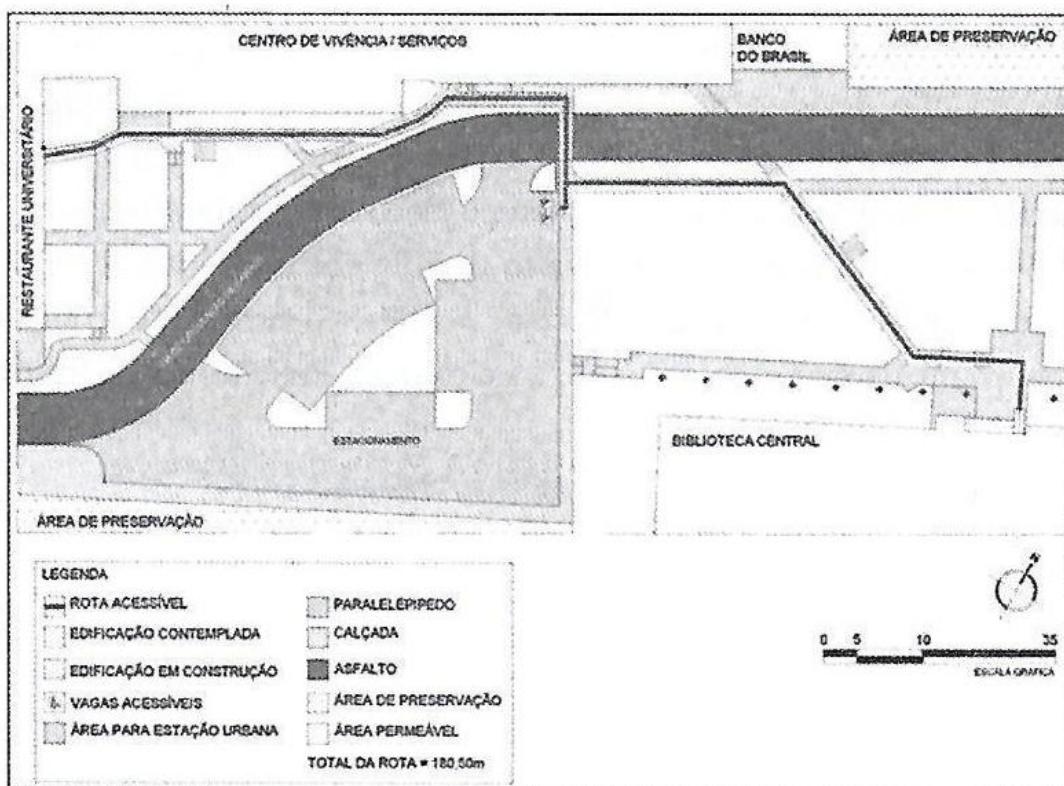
Planta Baixa da TPRA no Campus I – UFPB. Fonte: Acervo da pesquisa 2011.
